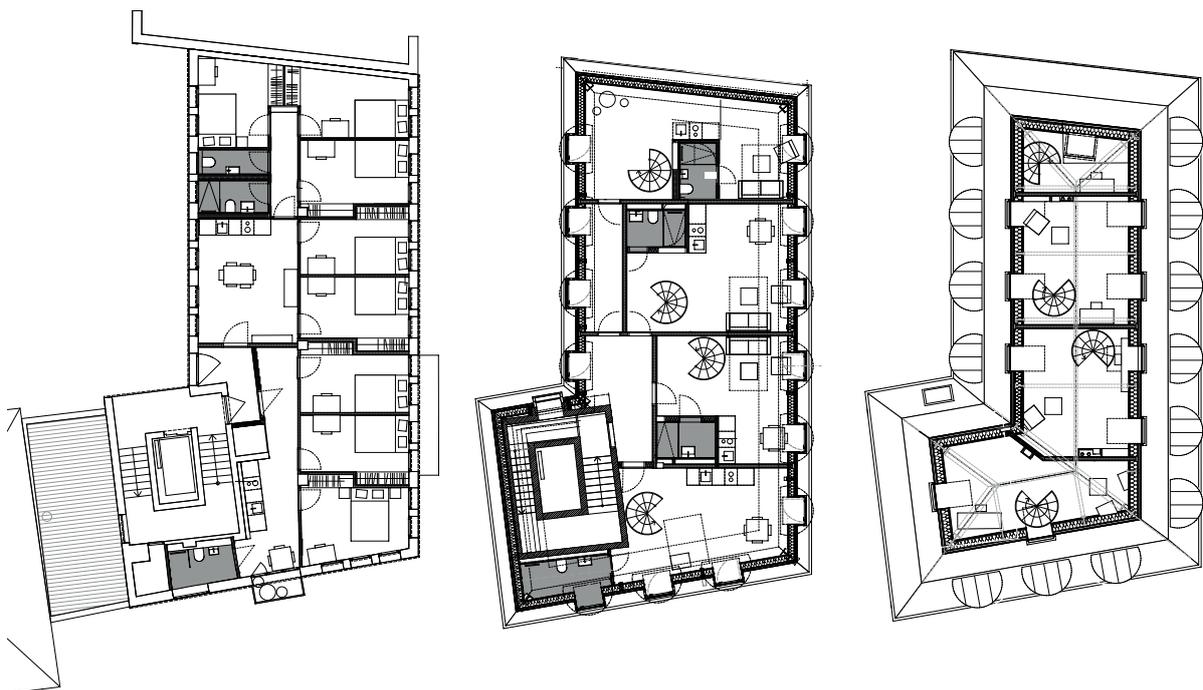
Grundriss Studentenapartment und Dachaufstockung
